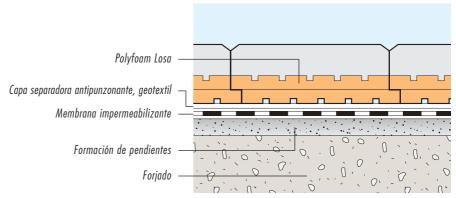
Lastrado baldosas con aislamiento térmico incorporado
